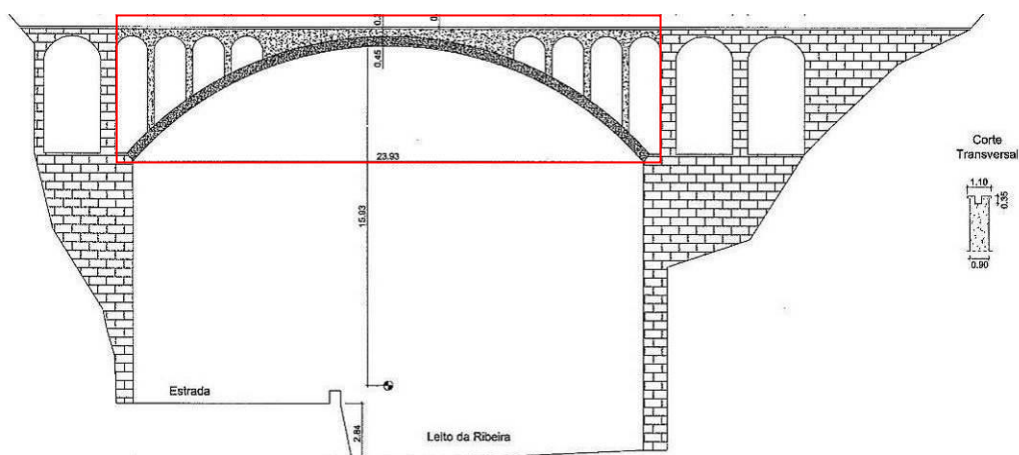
Vista jusante da ponte com indicação da zona construída em betão armado.
